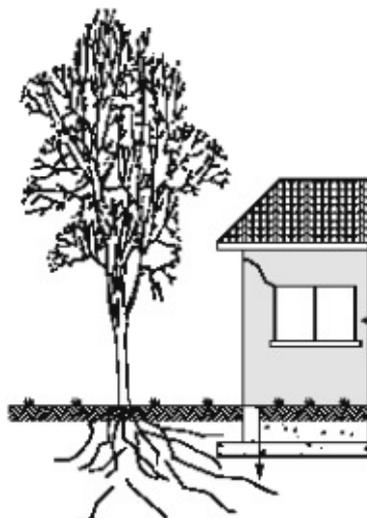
Fissuração devido ao assentamento do apoio provocado pela contracção do solo (Pereira, 2005) [w₆₂]
